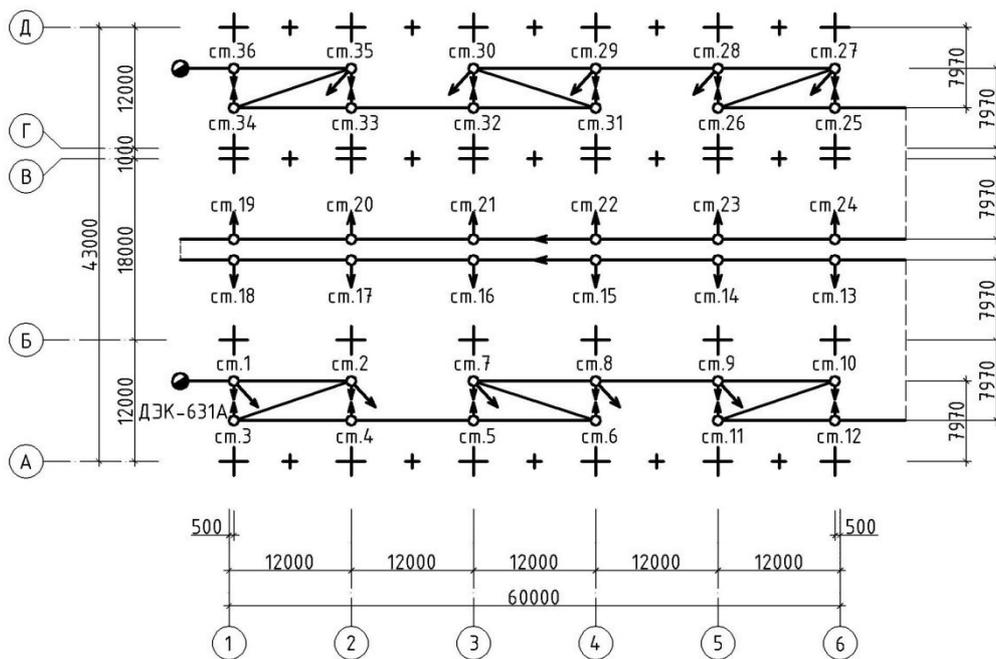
Схема проходки крана при монтаже колонн каркаса здания в осях А-Д (1-6)
